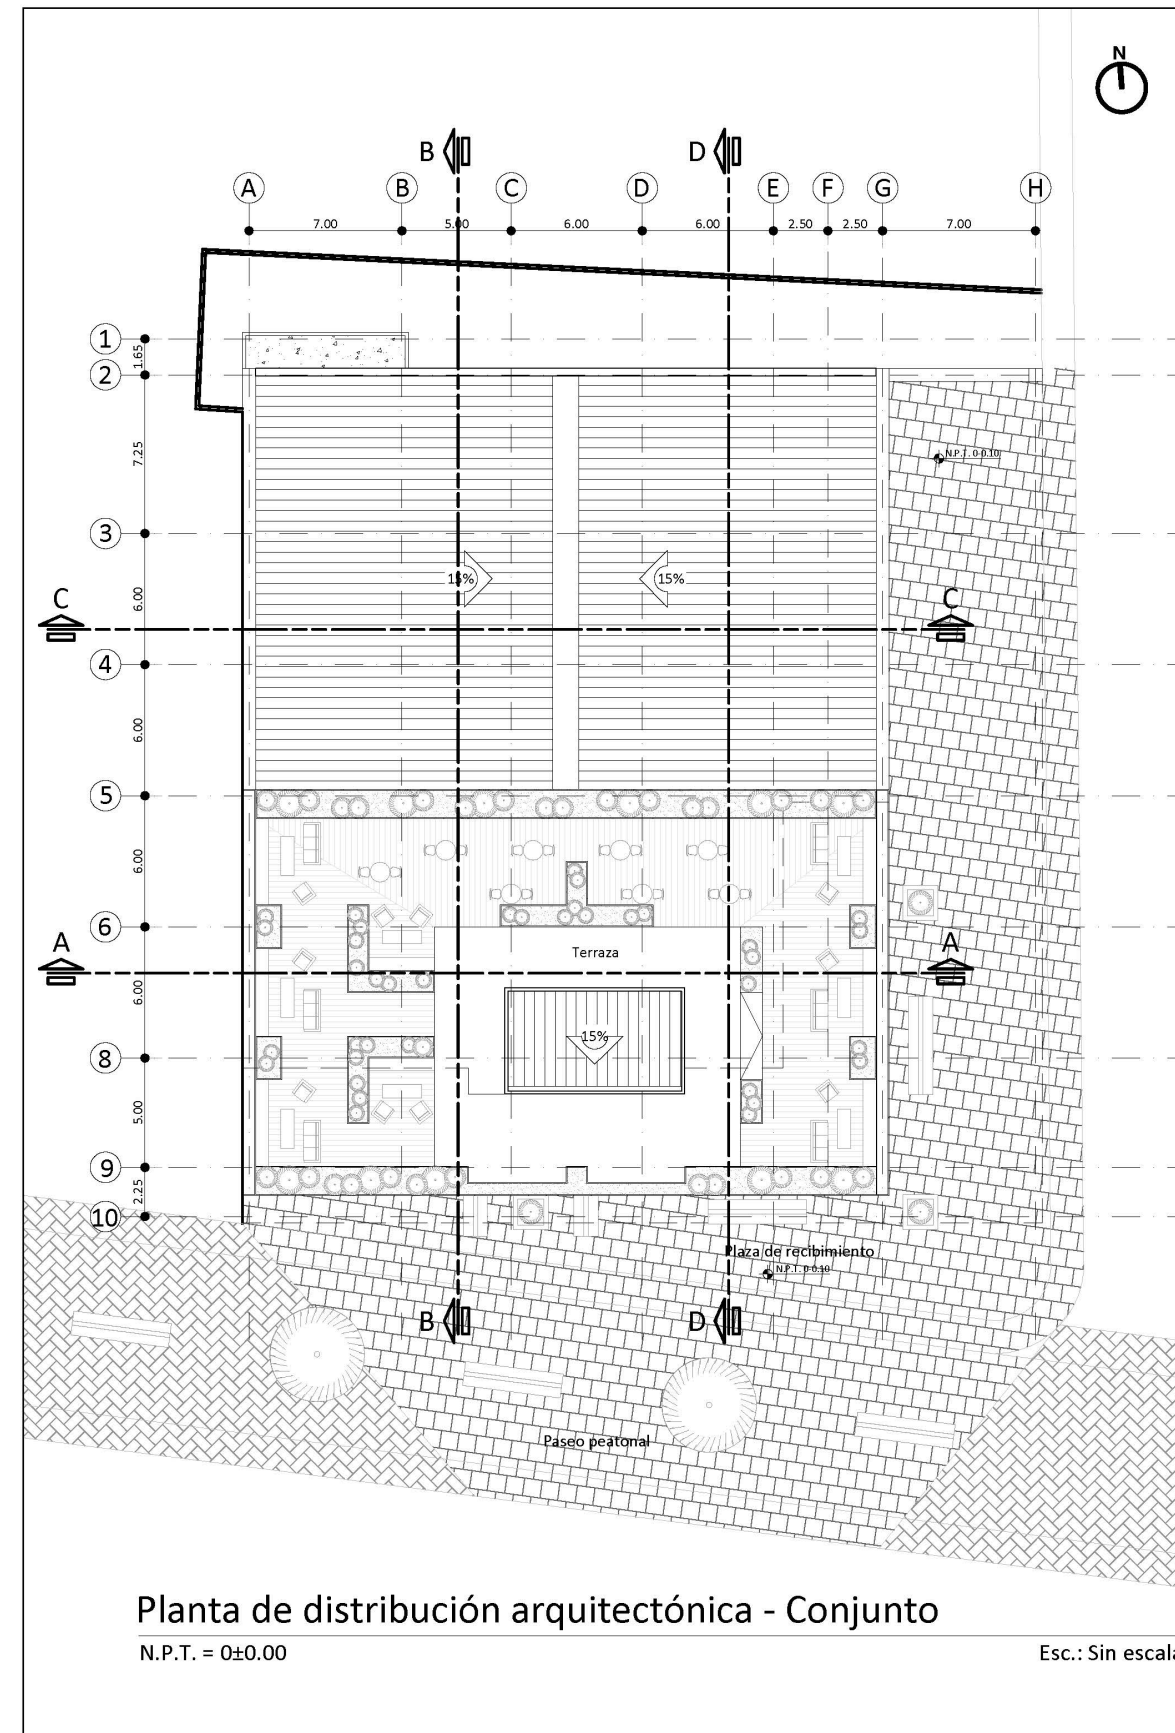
Planta de distribución arquitectónica de conjunto. Fuente: Propia.
